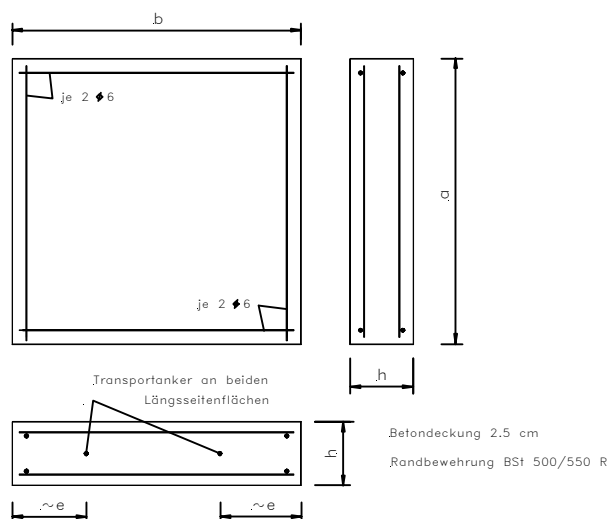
Typische montagebewehrte Betonplatte für zentrische Ausziehversuche im ungerissenen Beton.
